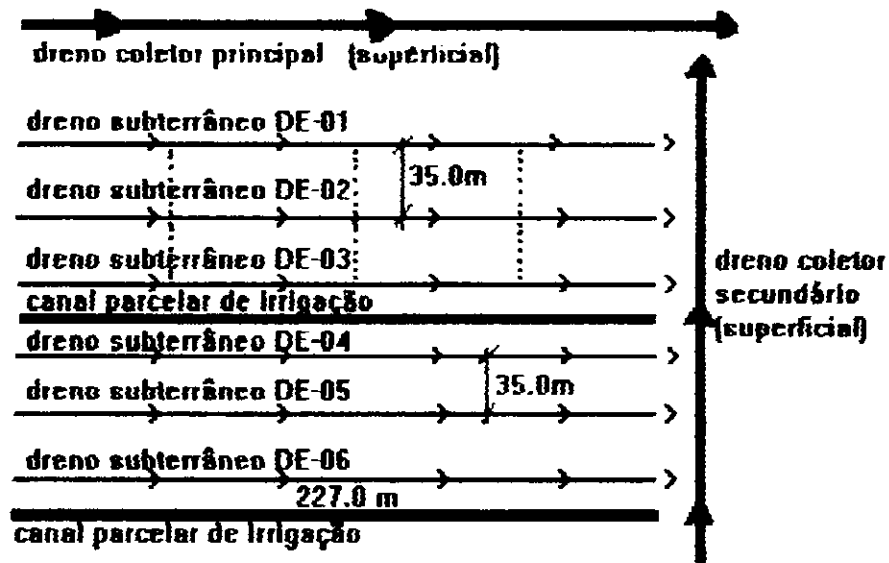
Layout do lote 059 do ensaio 02 do perímetro Bebedouro
